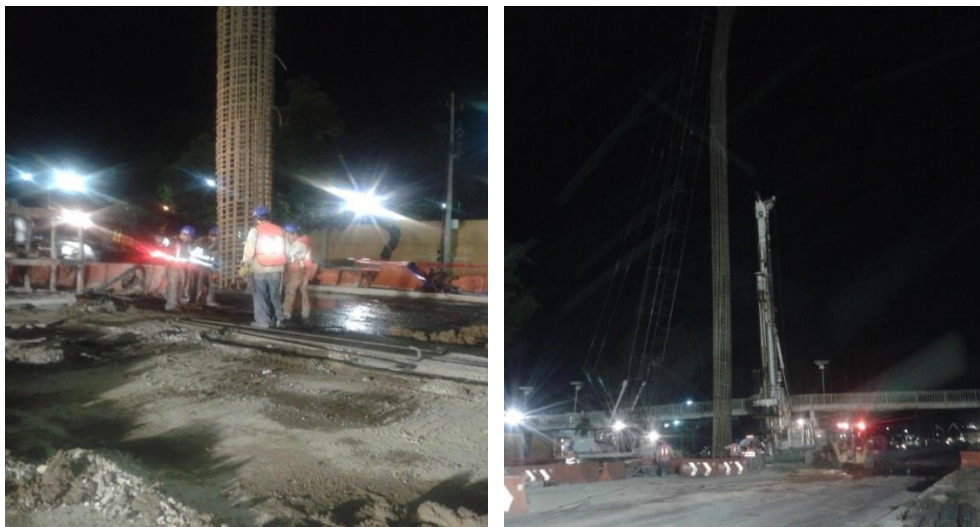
Refuerzo estructural de pilas AUN y AUS.
